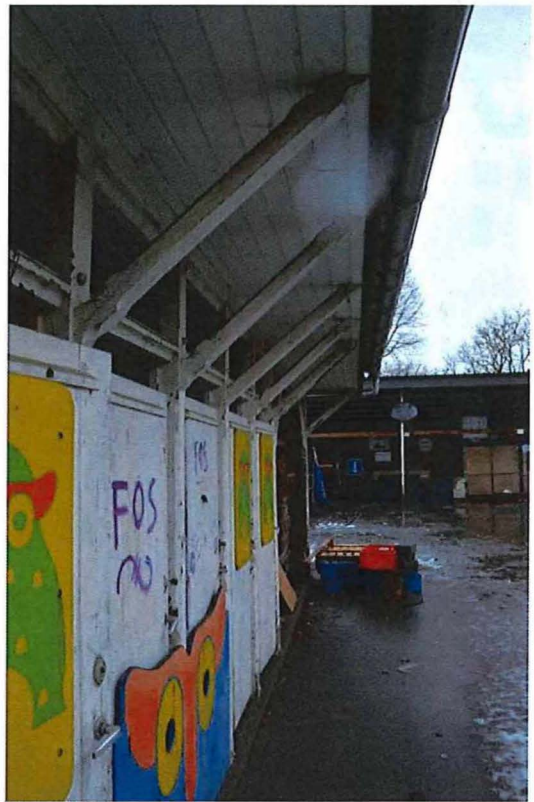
Sanitaire blok, detail dakoversteek (13/12/2017).
